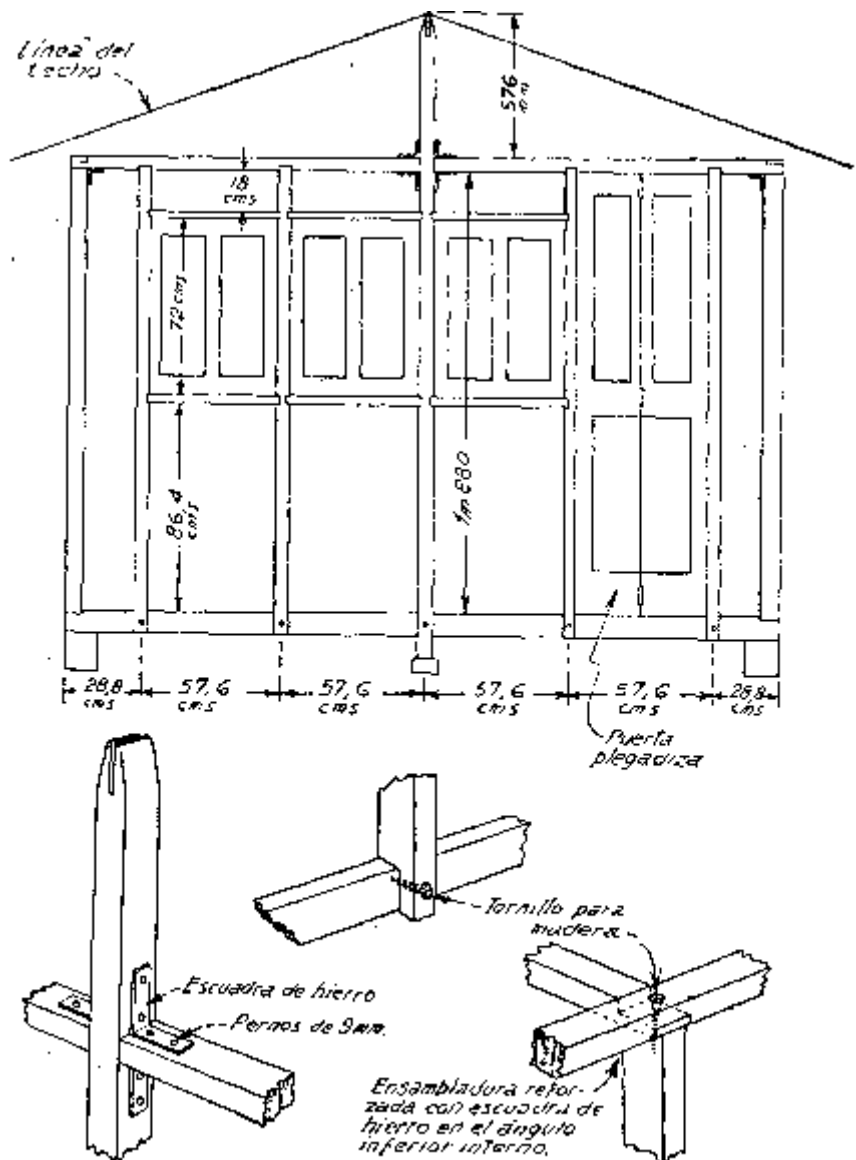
Los paneles que se ubican entre los montantes se proveen de escuadras metálicas preparadas para ser fijadas con pernos. La puerta plegadiza ahorra espacio en el interior.
